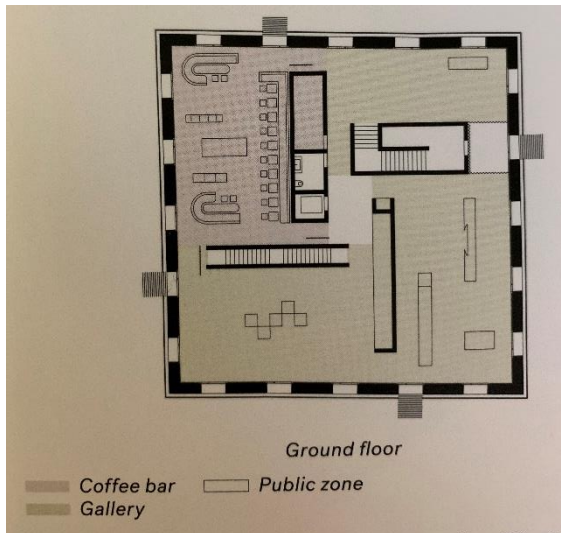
Bürohaus 2226, schématický půdorys a řez [3]
